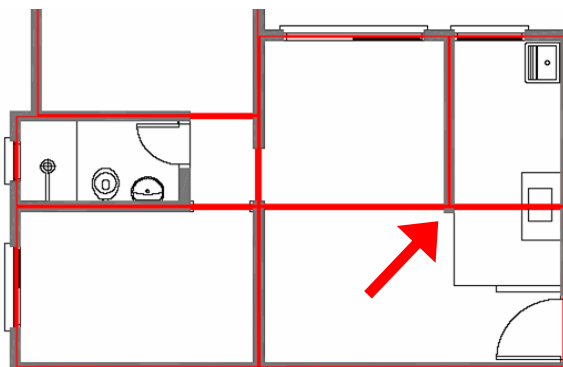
aumento do apoio dos painéis de laje da sala, da cozinha e da área de serviço
